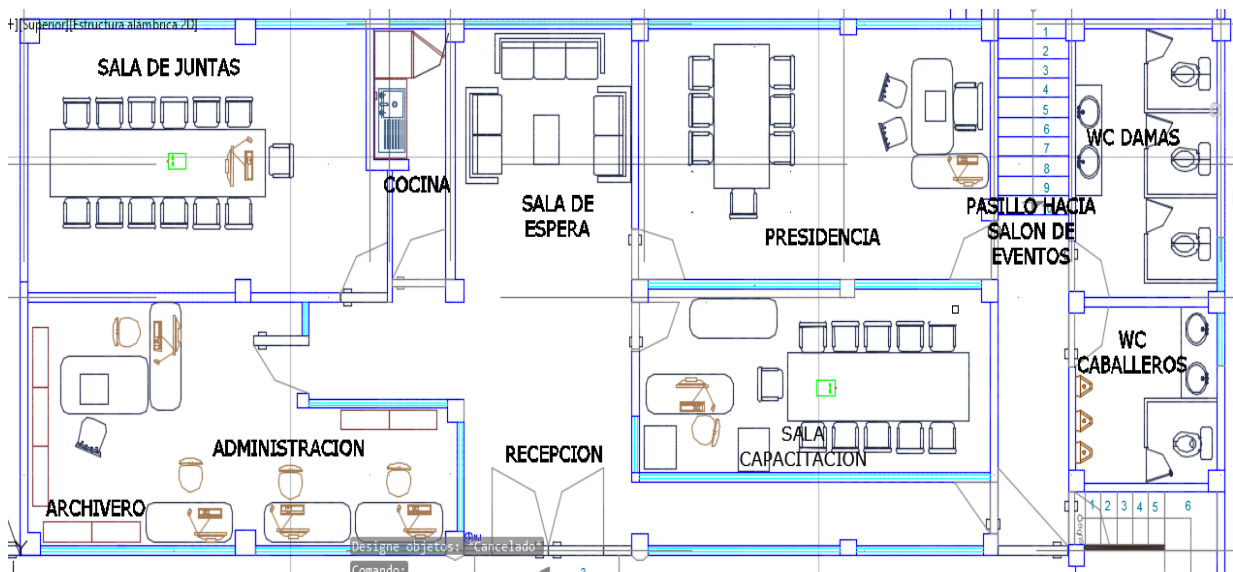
Plano de la primera planta del colegio de ingeniería eléctrica, salón de enteramiento y entrada al salón de eventos.
